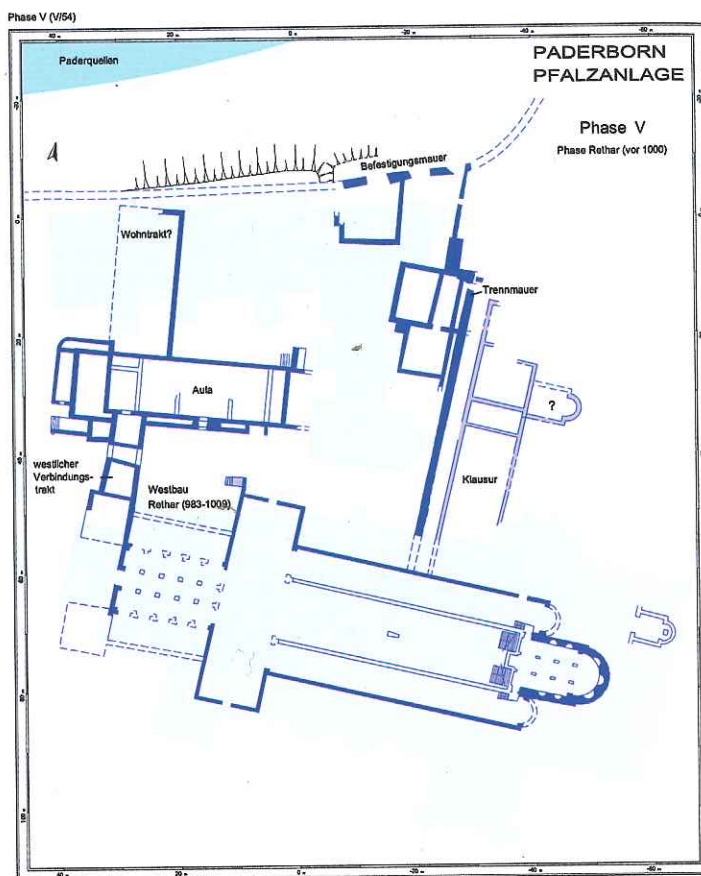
Paderborn. Pianta della fase V (progettazione: Sveva Gai und Birgit Mecke /ricostruzione grafica: Olga Heilmann).
